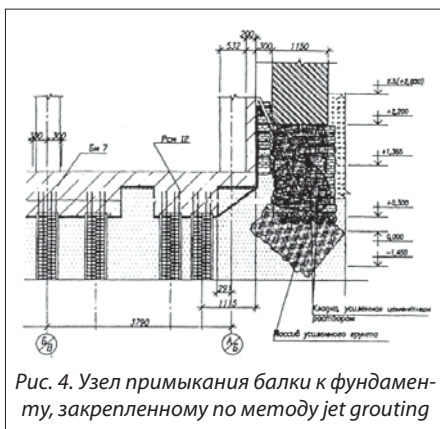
Узел примыкания балки к фундаменту, закрепленному по методу jet grouting
